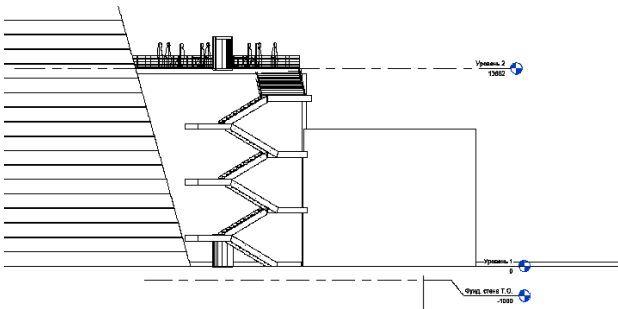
Архитектурно-планировочное решение (фасад - западный)
